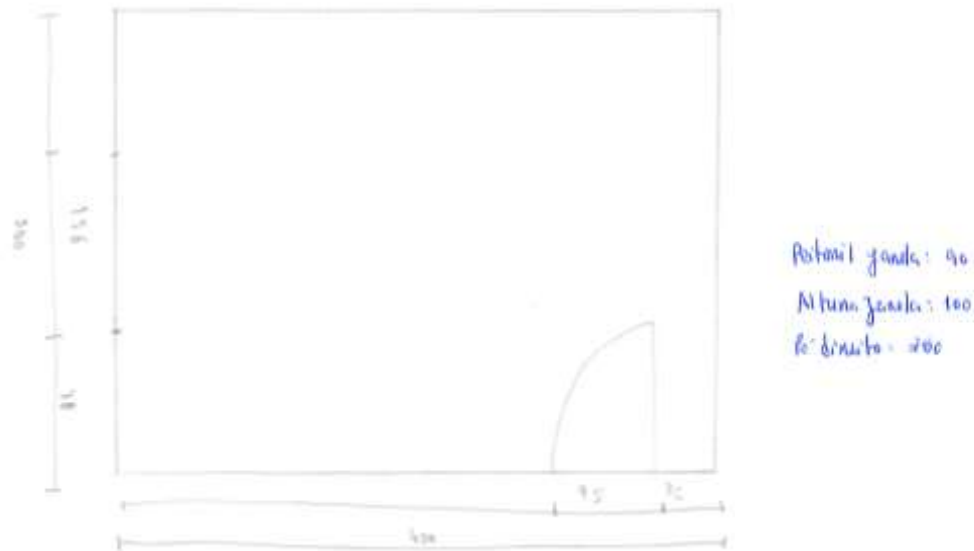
Levantamento das dimensões da sala de piano – Planta à mão levantada
